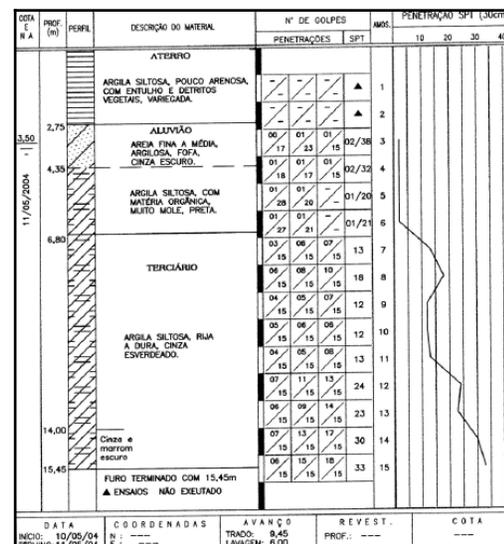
Perfil Geotécnico – SP - 03 – Córrego Sumaré
